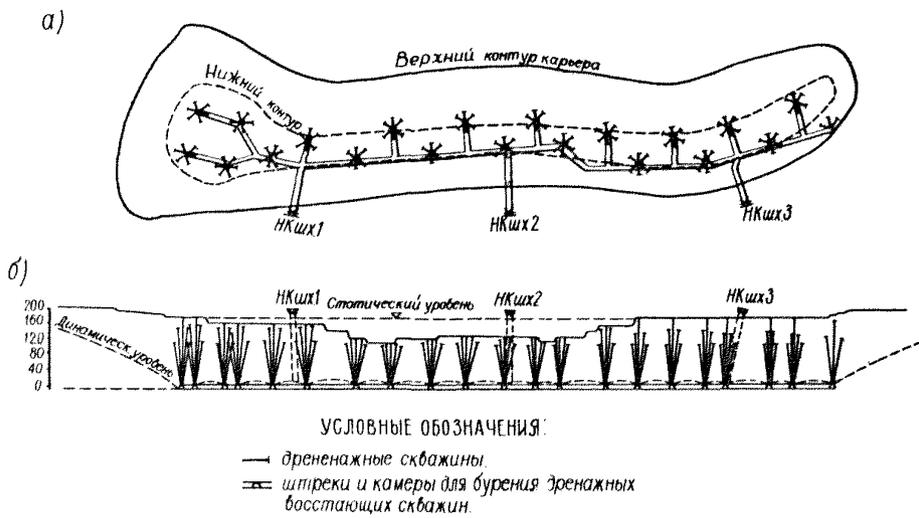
Схема подземного способа осушения на Экибастузском карьере: а - план; б - вертикальный разрез.
